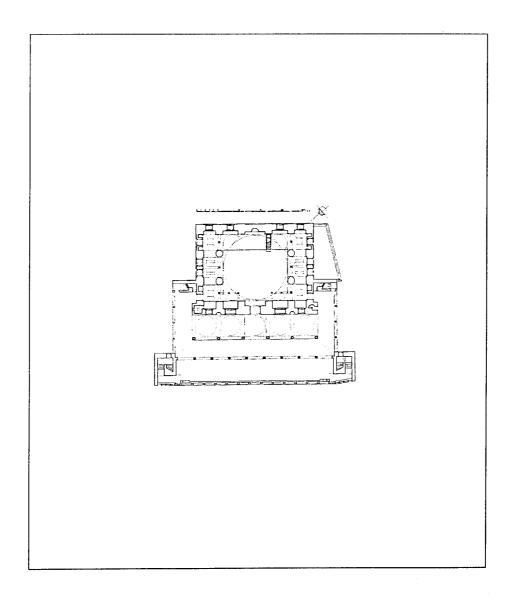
مسقط أفقي لمسجد جوزليج حسن بك في خيرا بولو (عن : كوران) .
